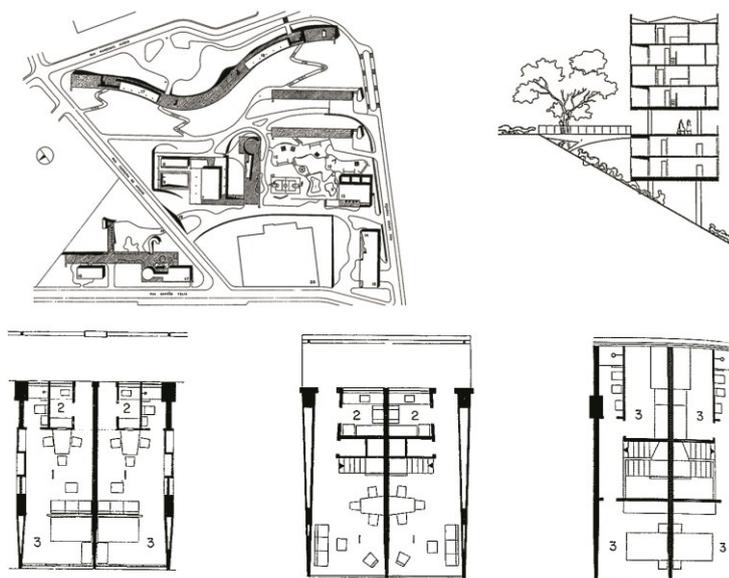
Plantas Conjunto Residencial Prefeito Mendes de Moraes: Situação, Corte Esquemático e Plantas dos Apartamentos (fonte: MINDLIN, 2000).
